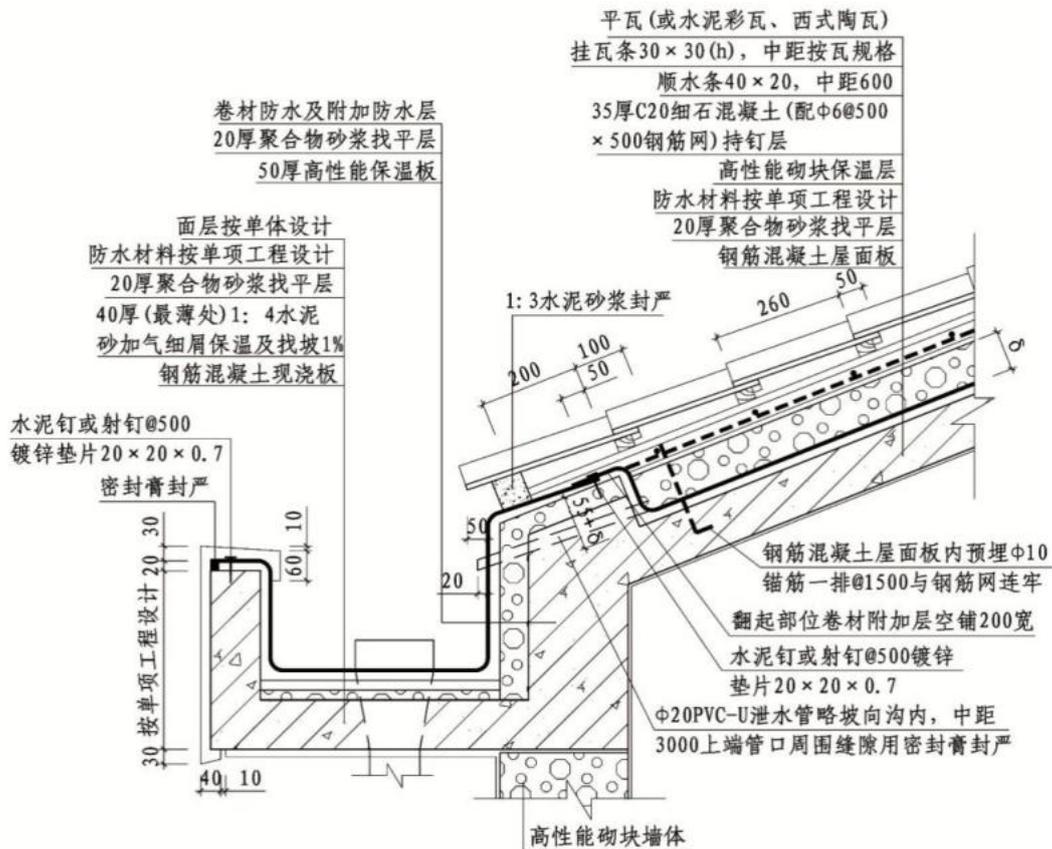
屋面保温防水构造 (坡屋面)
